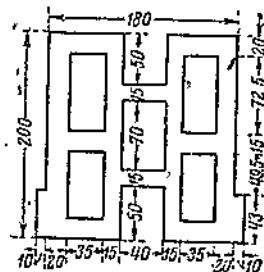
Блок для балок и сплошных перекрытий без металлических и железобетонных балок.
